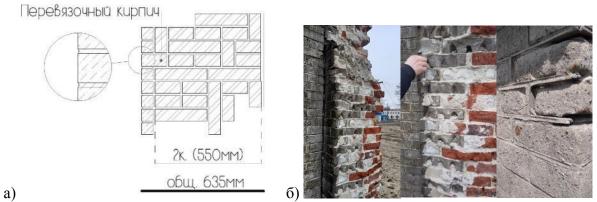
a) – конструкция наружной стены многоквартирного жилого дома (схема), б) – неотапливаемого здания (фото)
